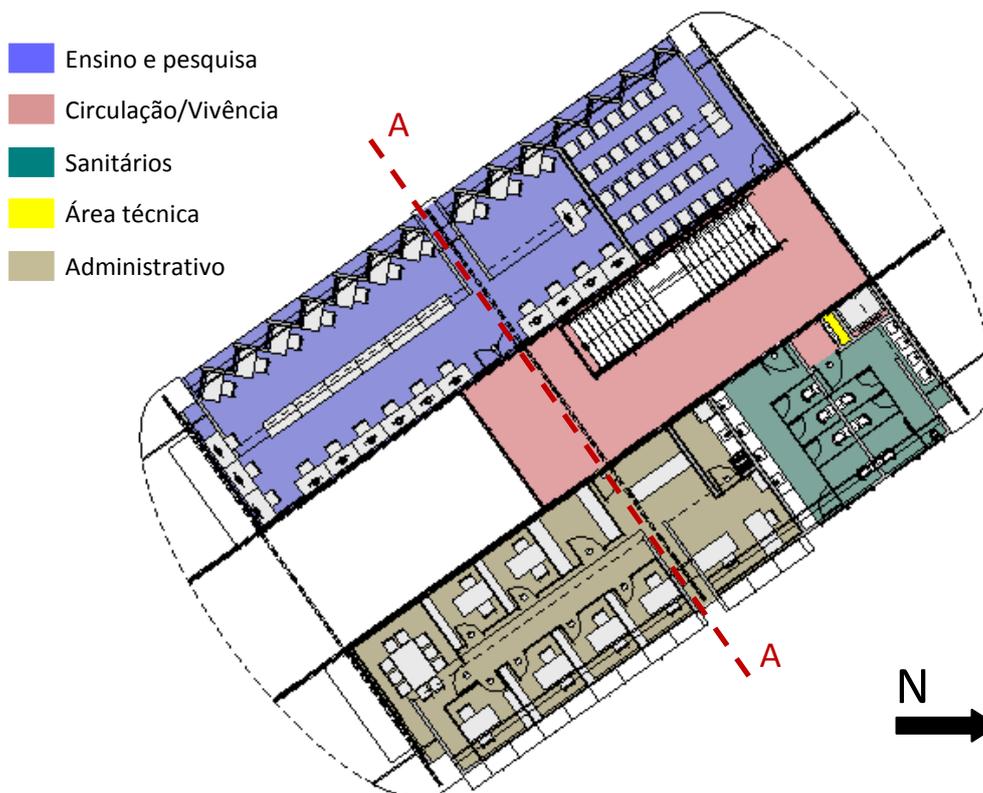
Planta baixa esquemática do 2º pavimento do NEM-CAR e sua setorização.
